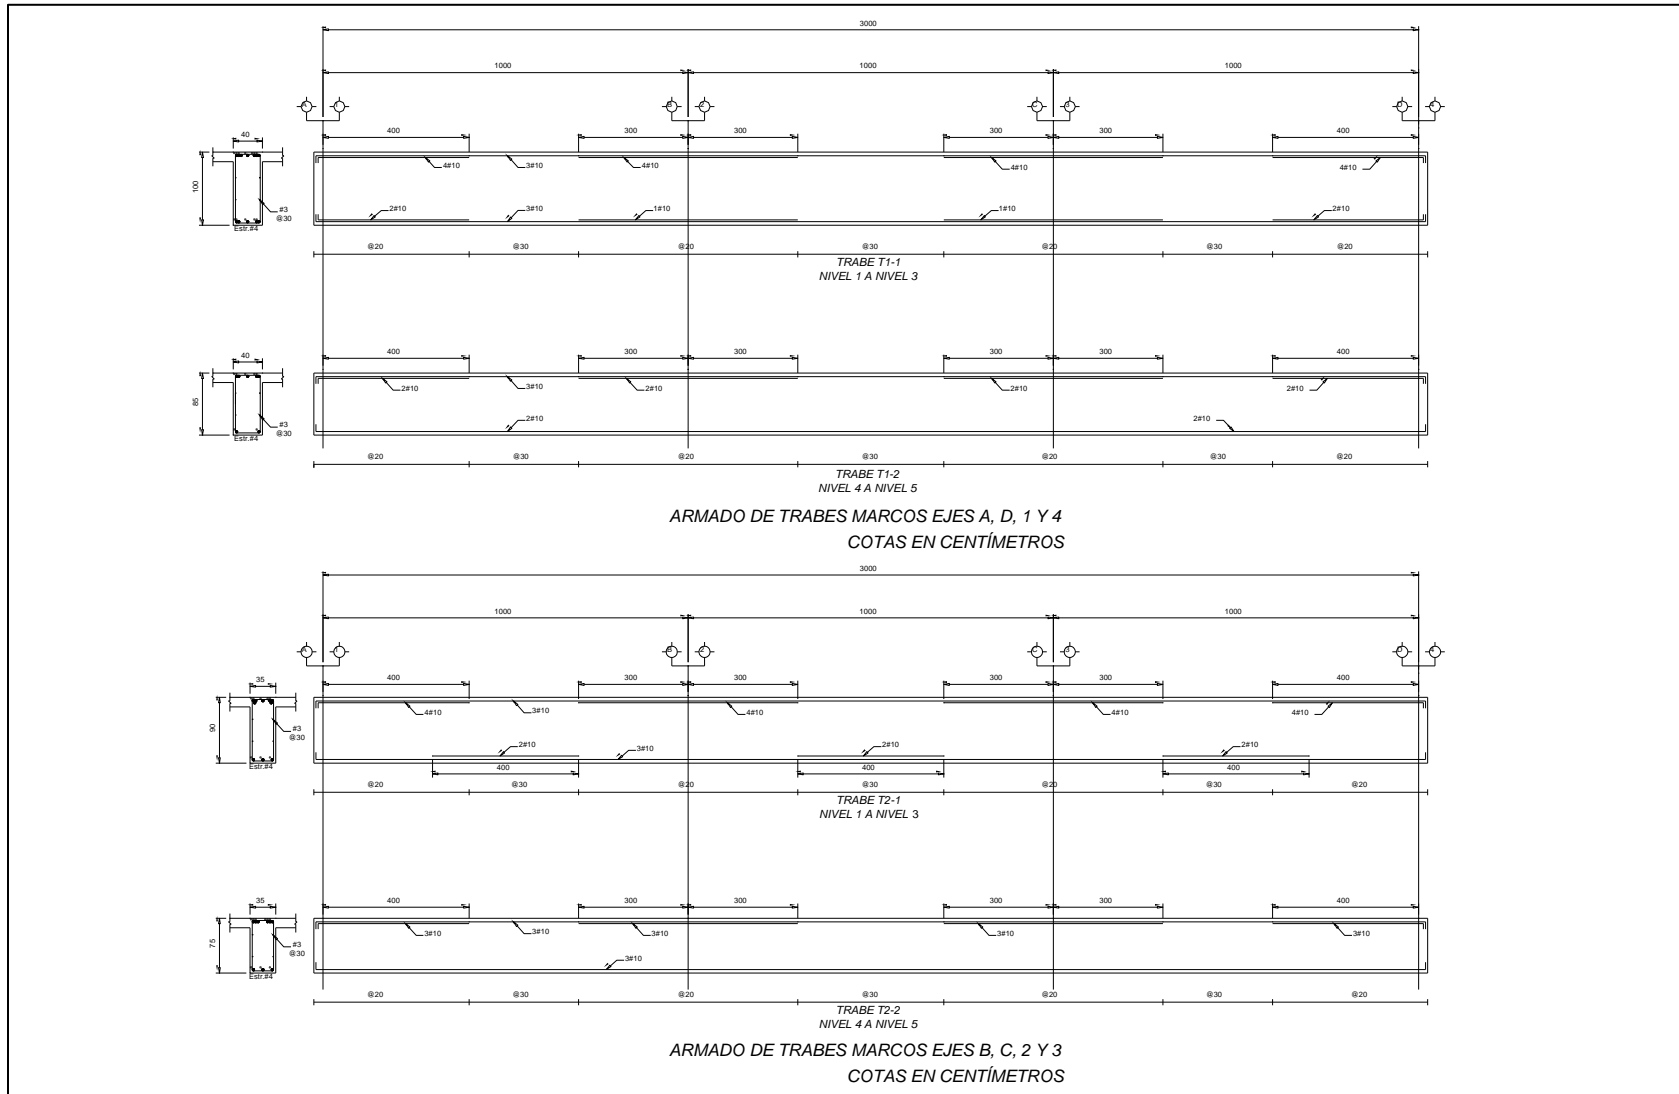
Detalles estructurales del edificio de 5 niveles diseñado con el ACI318-08
